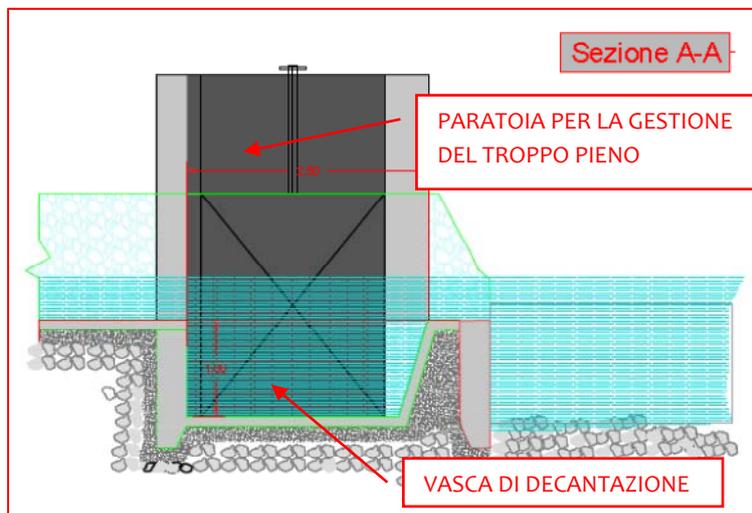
b Canale di derivazione - Sezione dell'imbocco
